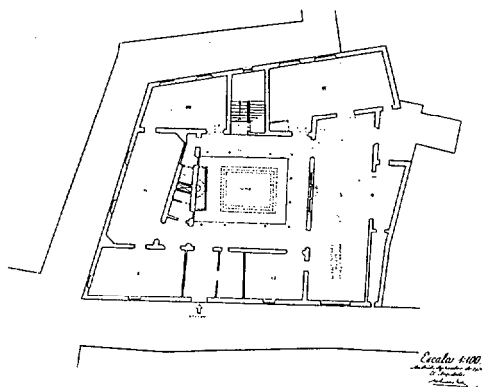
S. Zuazo. Proyecto de 1950. Planta baja.
